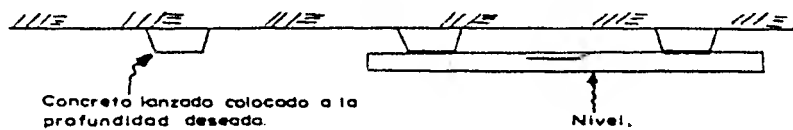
Reglas maestras para plafanes, muros y pisos .
